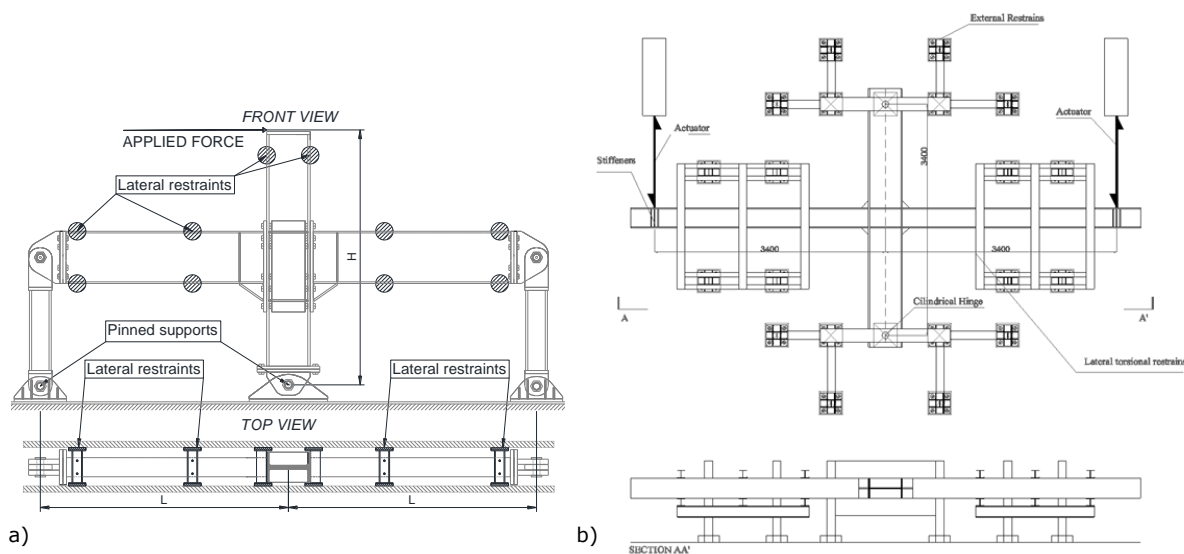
Configuração dos ensaios (a) junta testada na vertical (b) junta testada na horizontal
